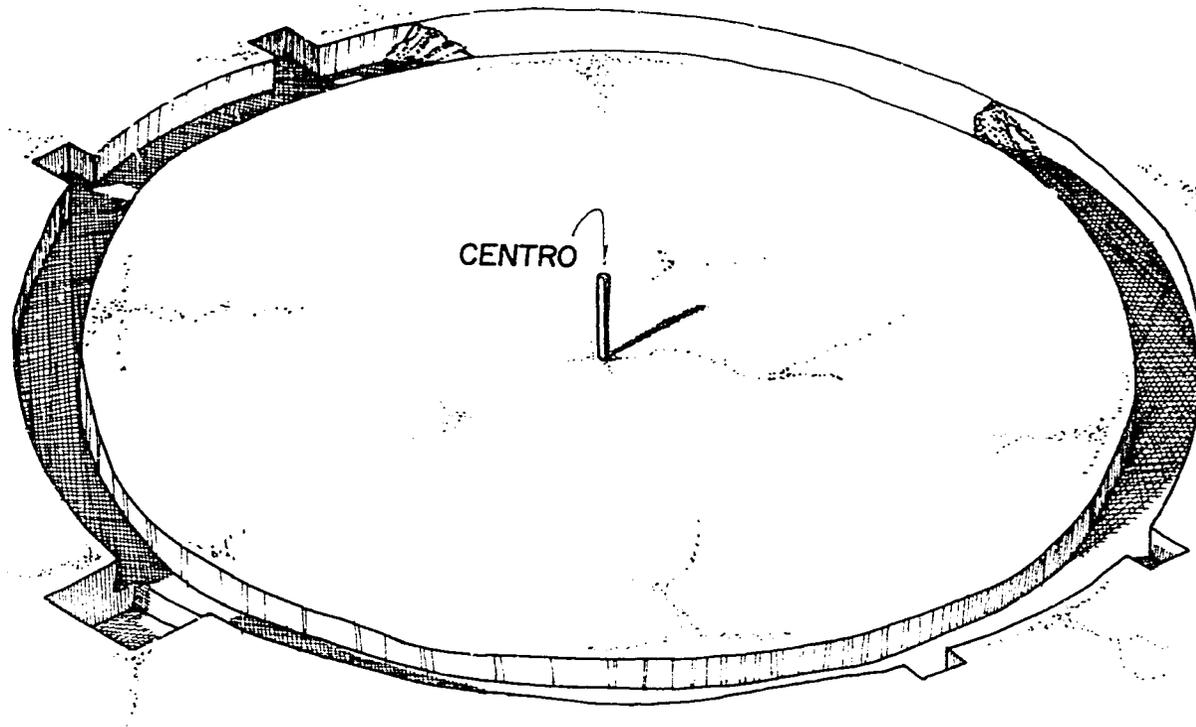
EXCAVACION DEL TERRENO PARA CONSTRUCCION DEL CIMIENTO.
